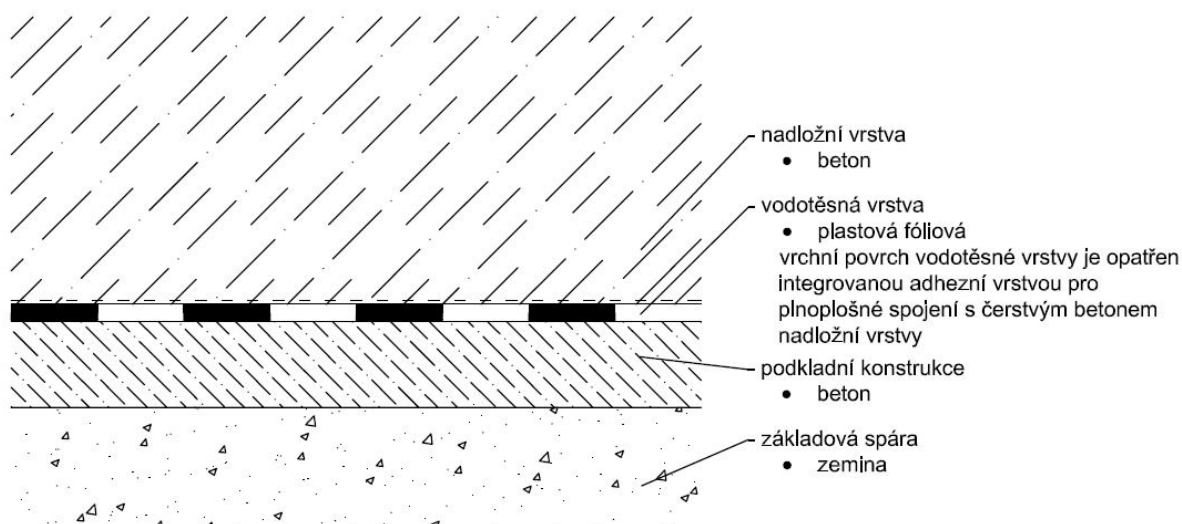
SVI volně položený na betonovou podkladní konstrukci, tvrdá ochranná vrstva – beton
